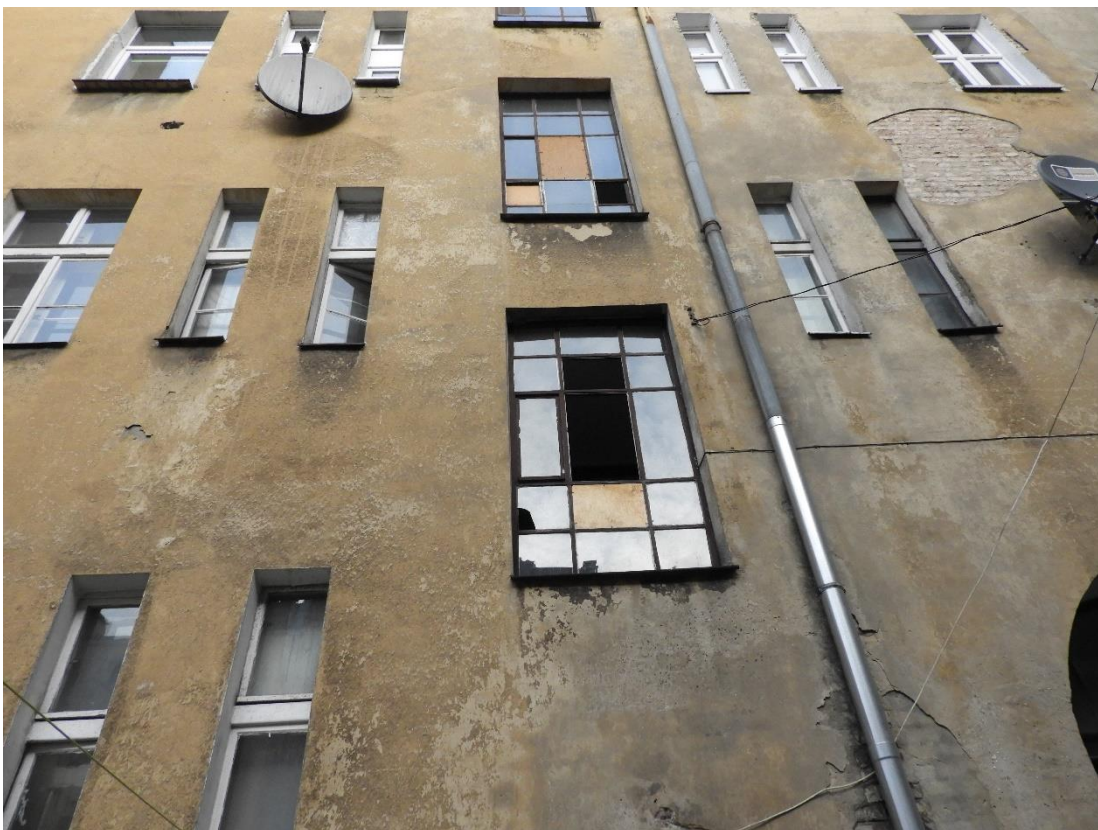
Elewacja od strony podwórza. Po lewej oficyna przy Kilińskiego 5.
